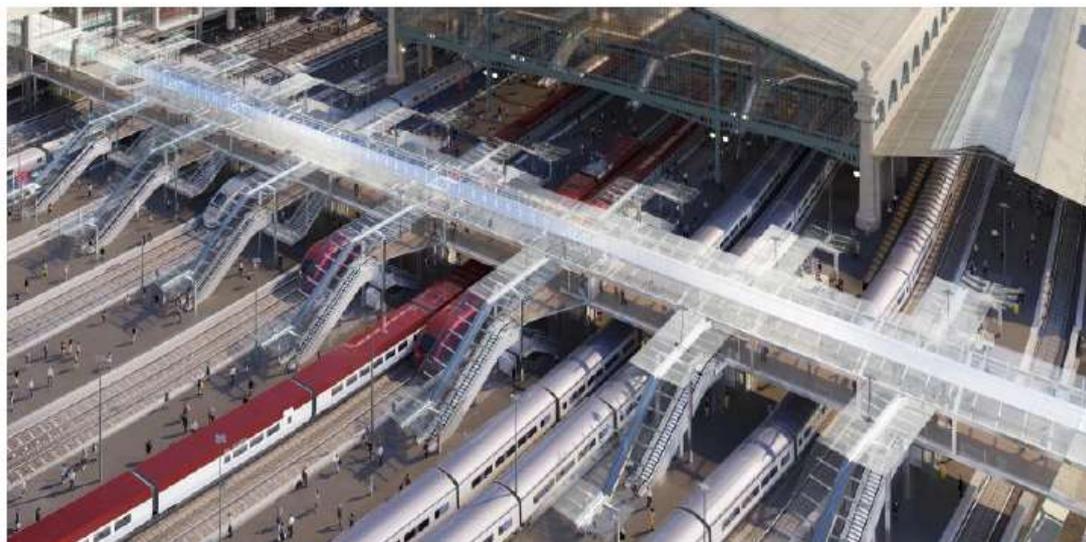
Les accès aux quais depuis la passerelle N°3 – Permis de Construire Modificatif
